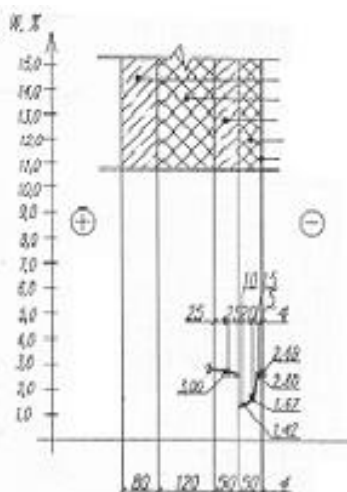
Распределение влаги по сечению стены с наружной теплоизоляцией плитами пенополистирольными ПСБ-С:
